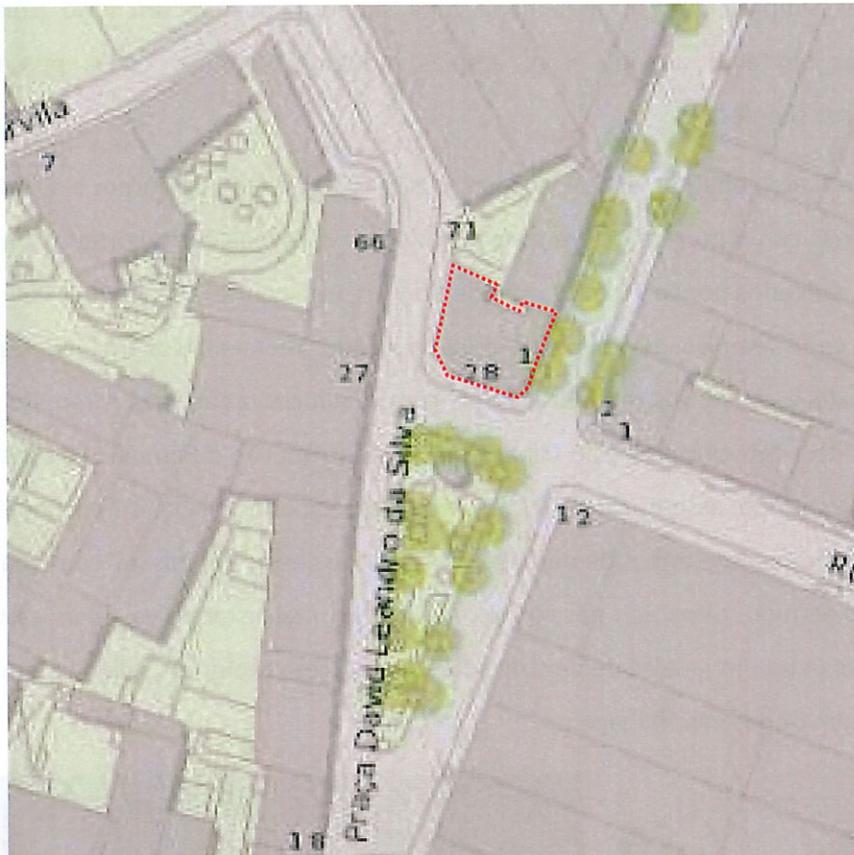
Planta de localização do Edifício Sede da Fábrica José Domingos Barreiro.
